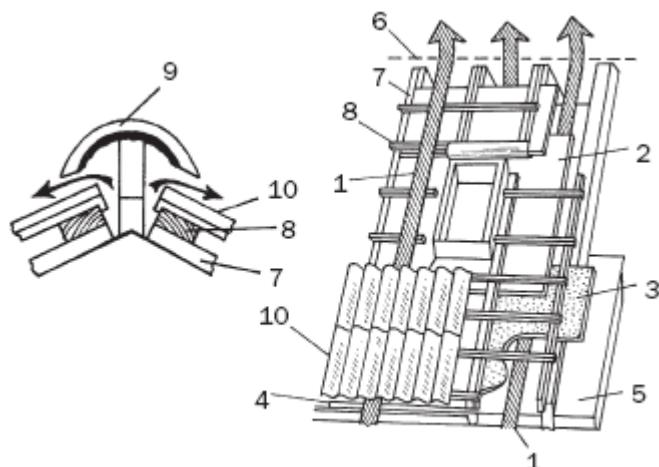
Конструкция крыши с улучшенной вентиляцией: 1 – потоки воздуха от карниза к коньку; 2 – парогидроизоляция; 3 – ветроизоляция; 4 – вентиляционное отверстие в карнизе; 5 – утеплитель; 6 – уровень установки конька; 7 – стропила; 8 – обрешетка; 9 – геометрия покрытия конька; 10 – кровля
